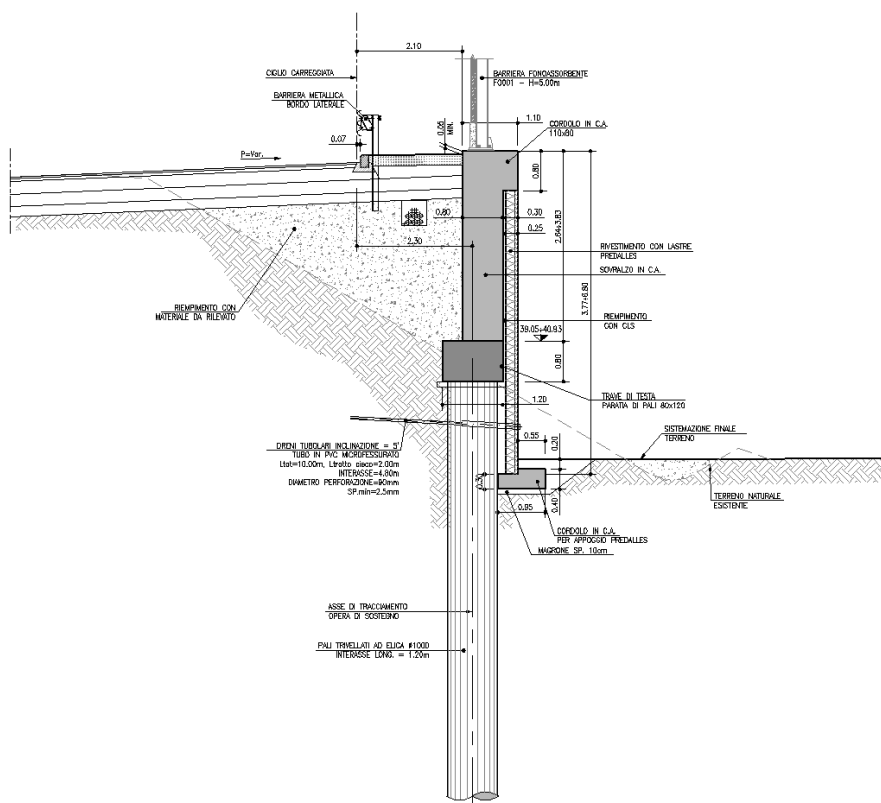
Sezione tipo opera di sostegno MS001 – Tratto con fondazione su pali e barriera fonoassorbente
